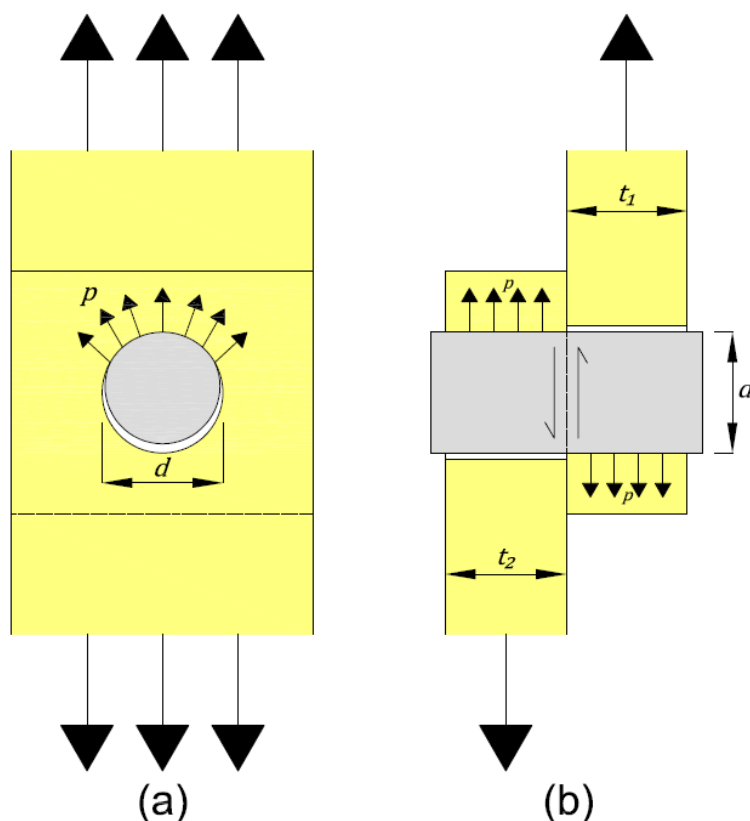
Ligação madeira-madeira em corte simples: a) alçado; b) corte.
